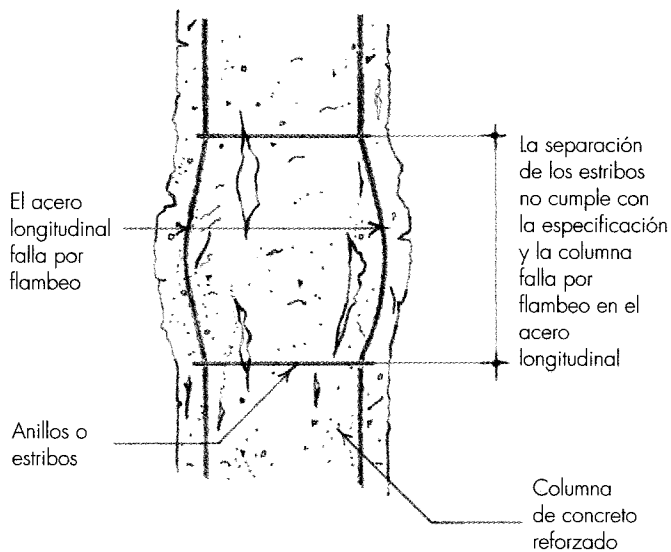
Las varillas longitudinales se flambéan y fracturan el concreto de la columna. Puede producirse un colapso súbito.
